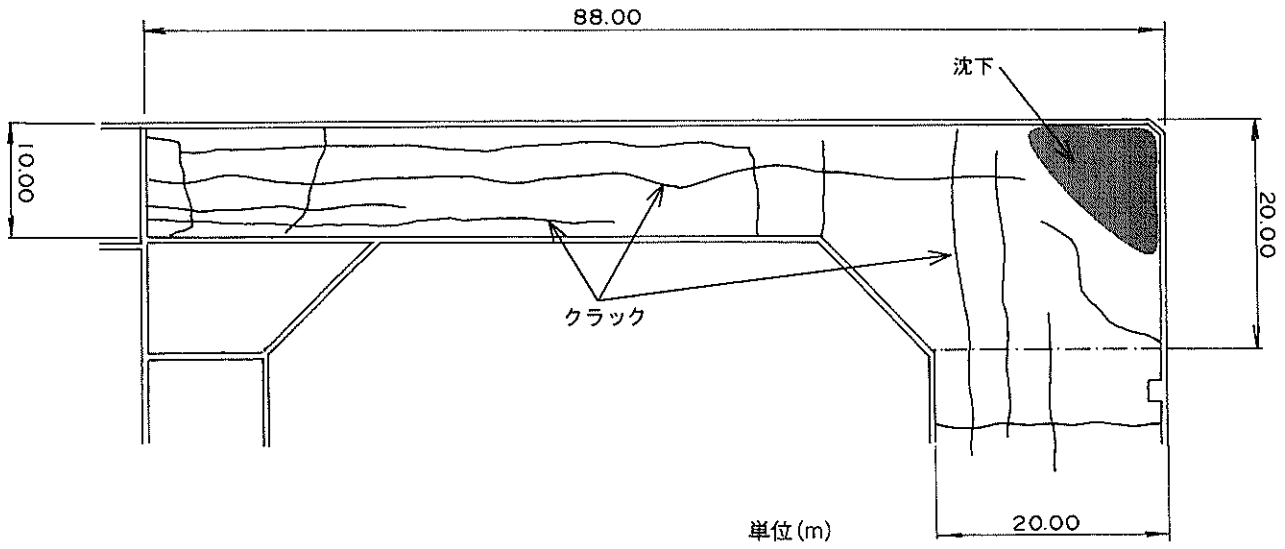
物揚場(-3.0m)(施設番号⑥)の平面図
